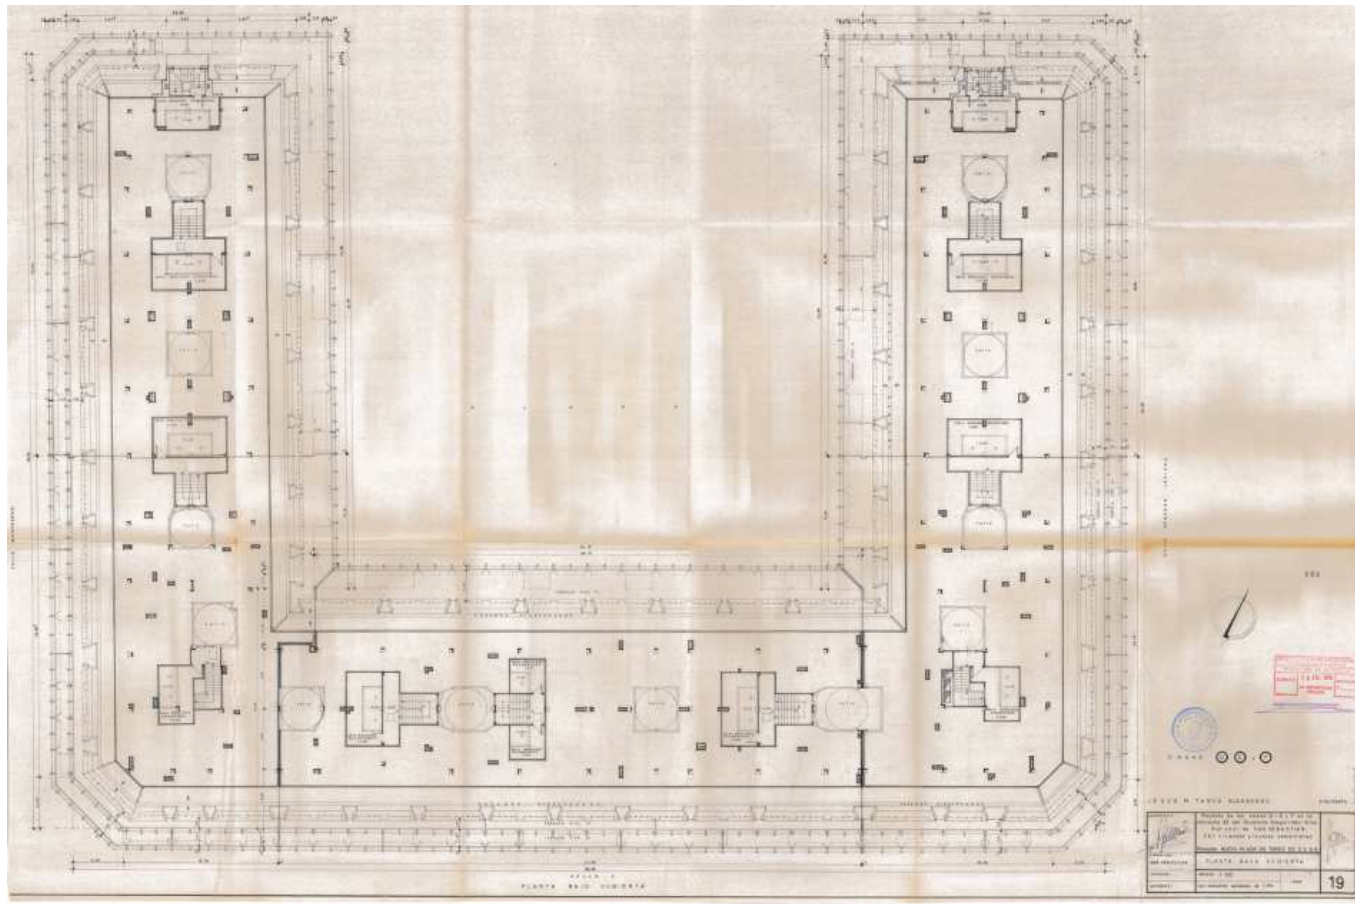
Plano original de planta baja de edificio de la Plaza del Chofre.
